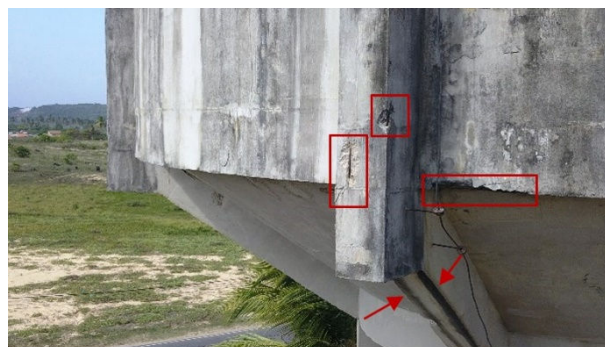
Vista da parede da cuba (face sudoeste), em destaque corrosão da armadura (retângulos) e manchas de umidade (setas)
